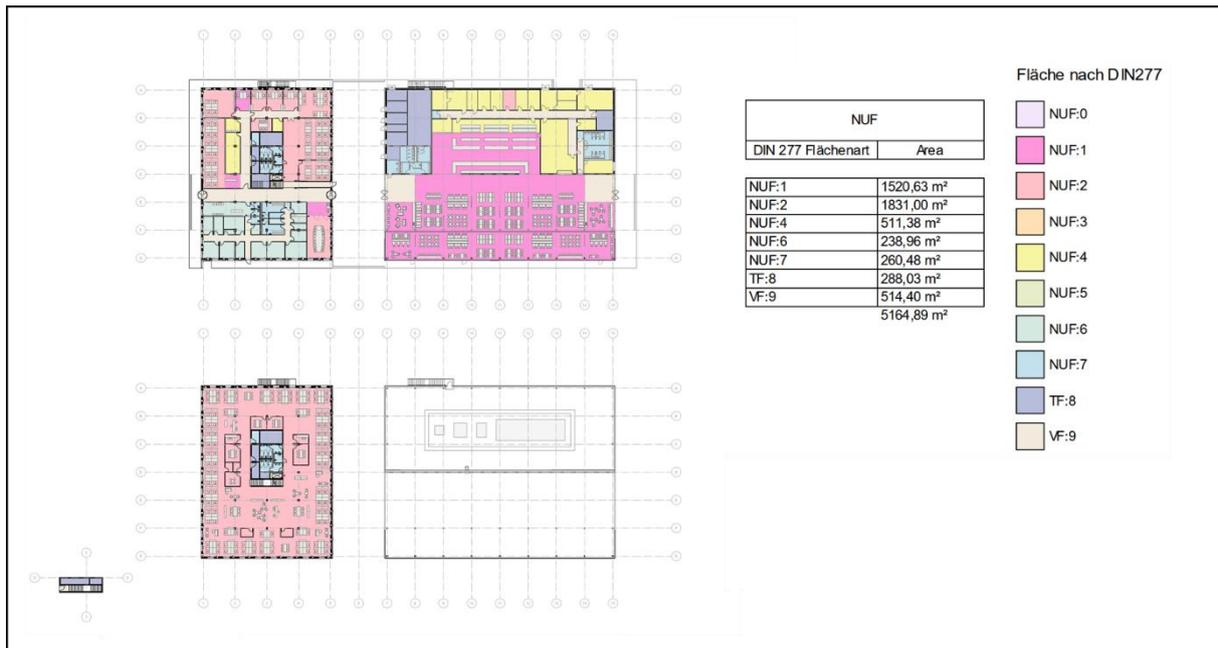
Communication Center - Grundriss Erdgeschoss und Obergeschoss, BA1+ BA2.
